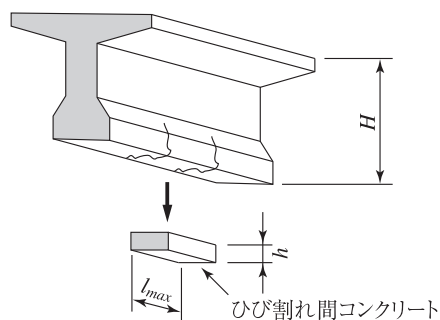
ひび割れ間のコンクリートの収縮挙動
